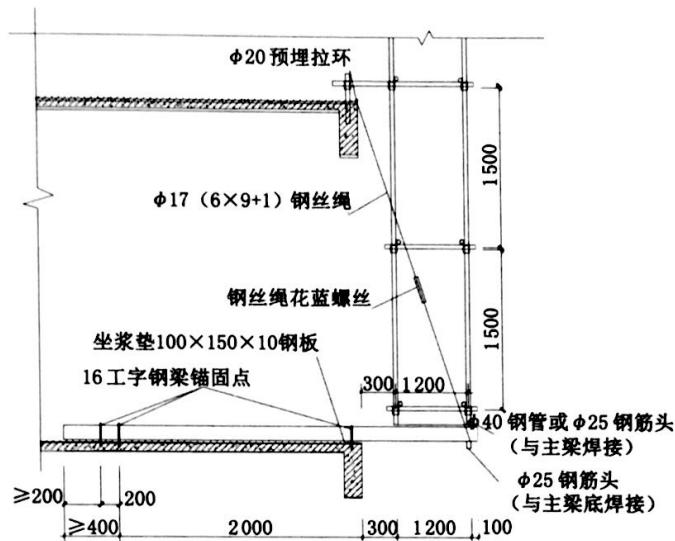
工字钢悬挑扣件式钢管脚手架立面图(单位: mm)
